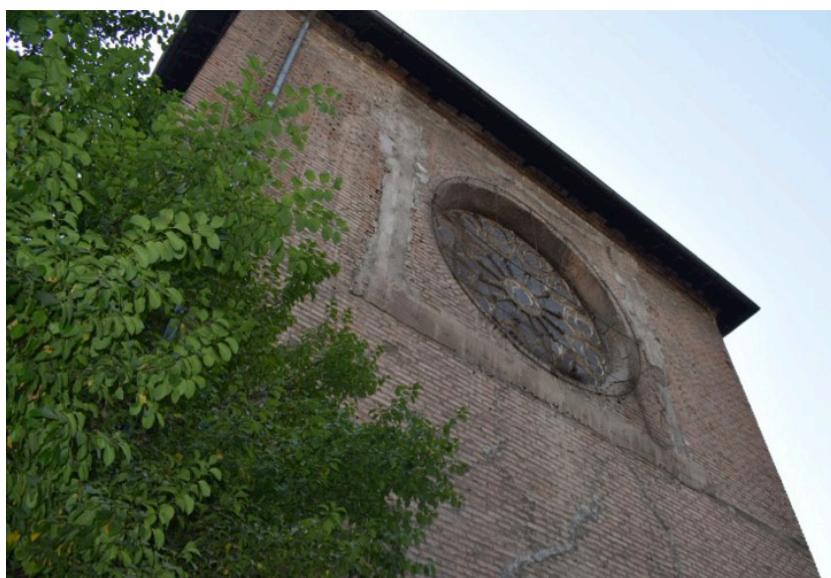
Refuerzos de hormigón armado en transepto poniente. Fuente: Consejo de Monumentos Nacionales [CMN] (2008).
